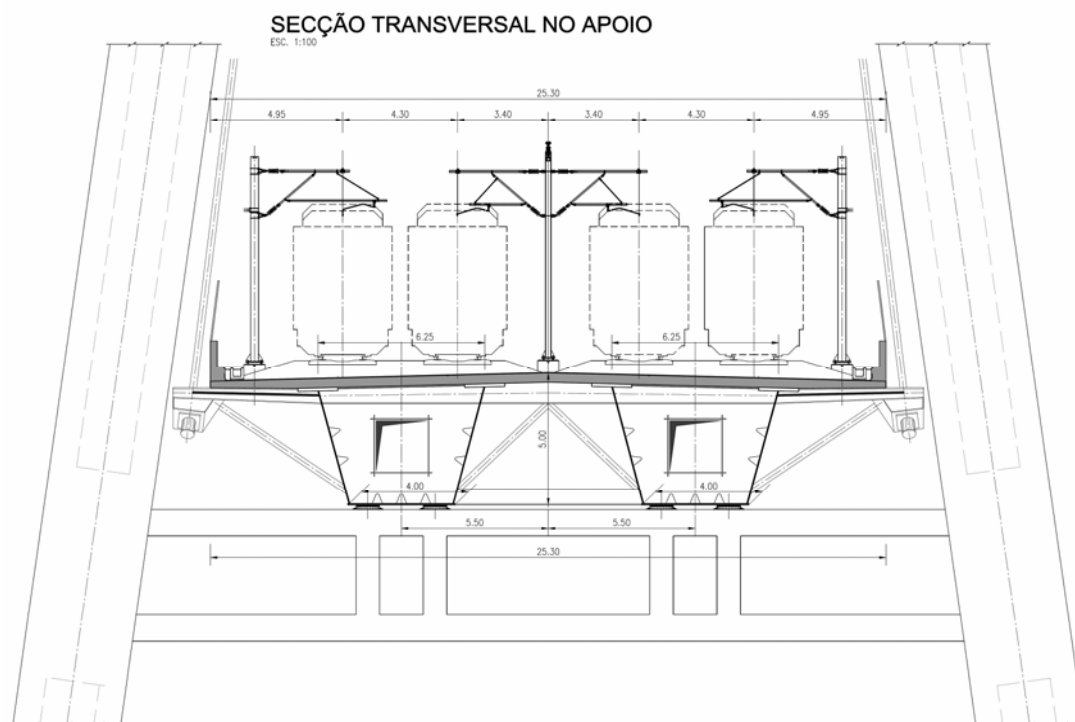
Secção transversal da travessia ferroviária Chelas-Barreiro (fonte: GRID, 2007)
